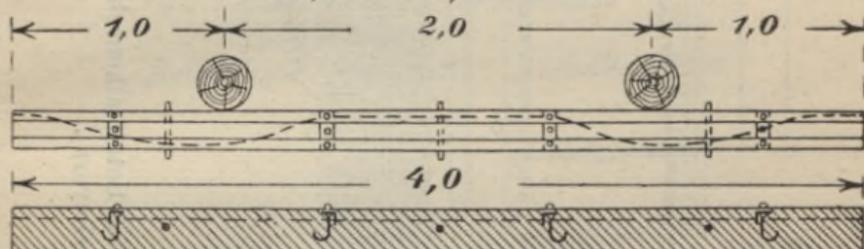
Schwellenquerschnitt mit Stauwand aus Eisenbetonbalken und Stangensturzbett.
